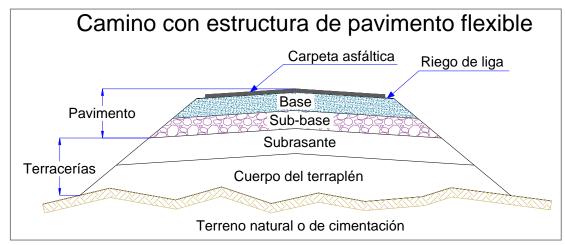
Camino con estructura de pavimento flexible, Ilustración, 2017
